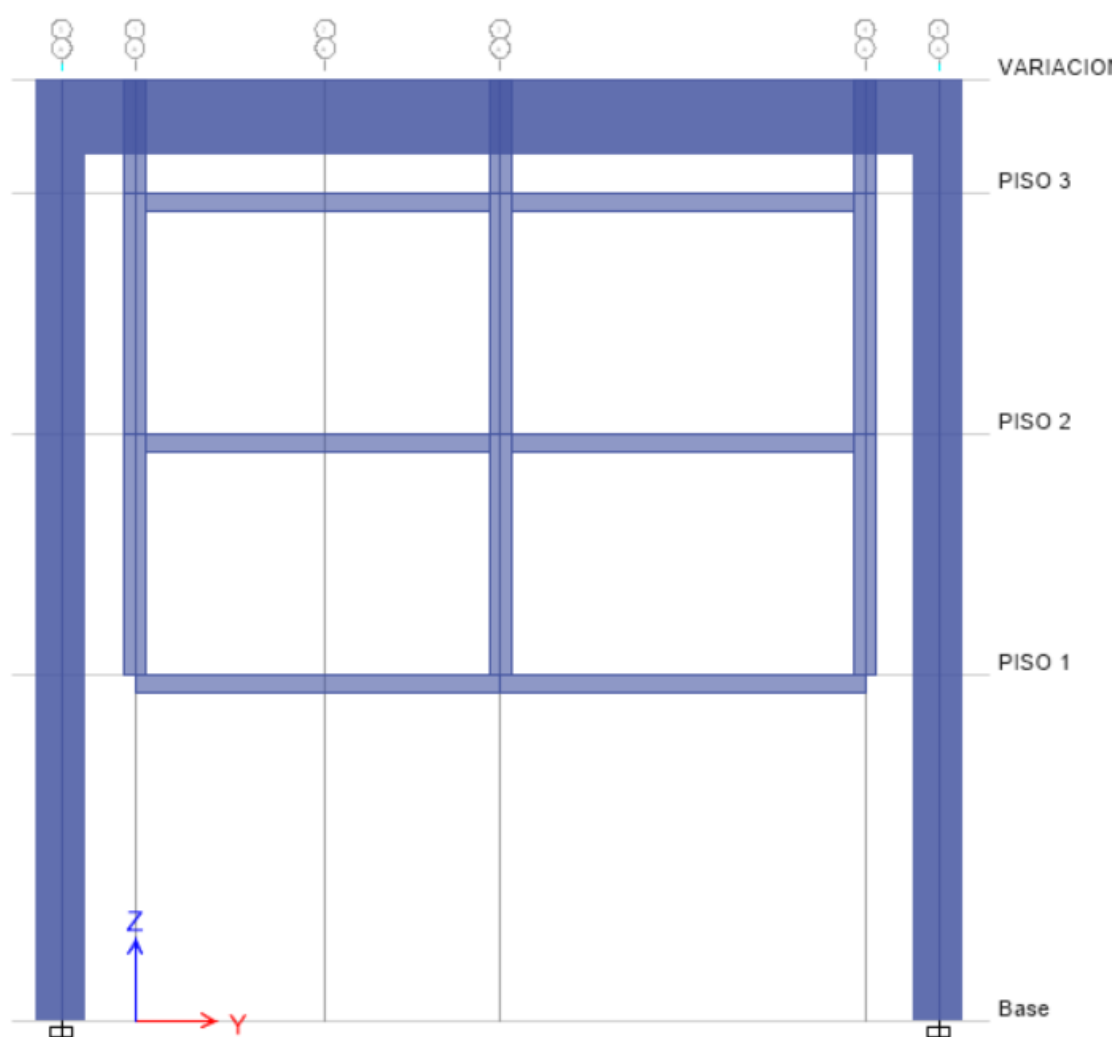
vista de perfil (extremos) del modelo estructural con sistema semi-colgante.
